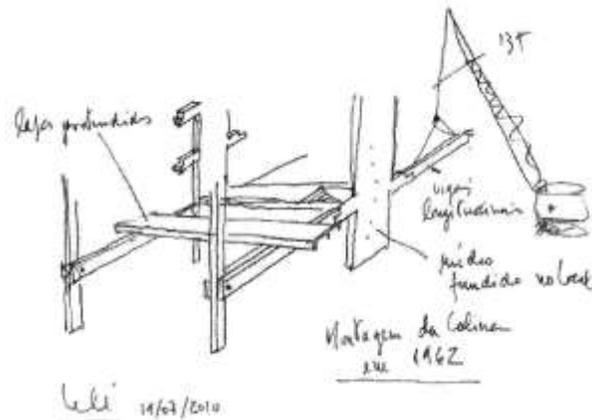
Croqui do sistema de montagem das lajes protendidas e vigas longitudinais. Fonte: MIYASAKA, 2014, p. 165.
